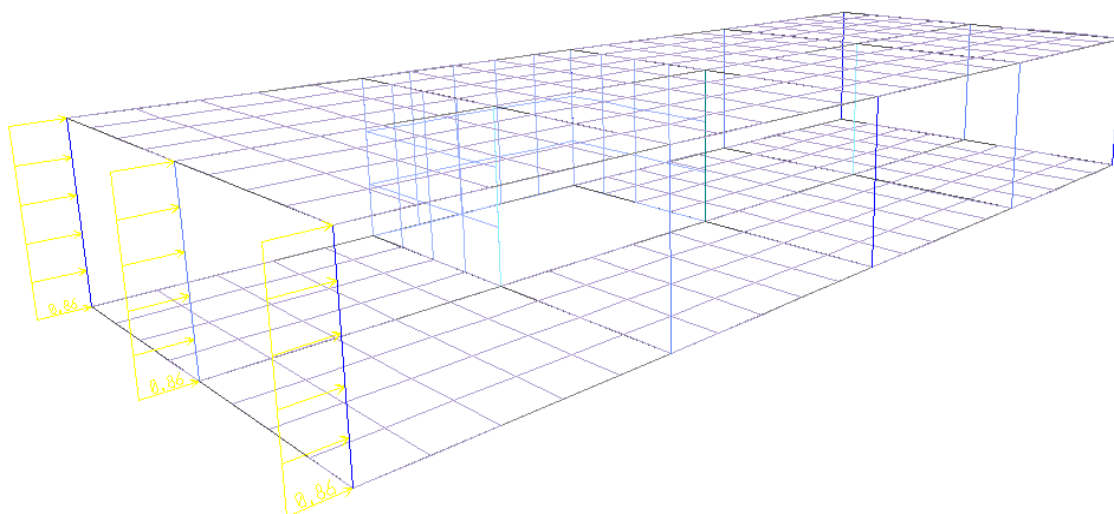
Aplicação do carregamento de vento ao longo dos pilares
